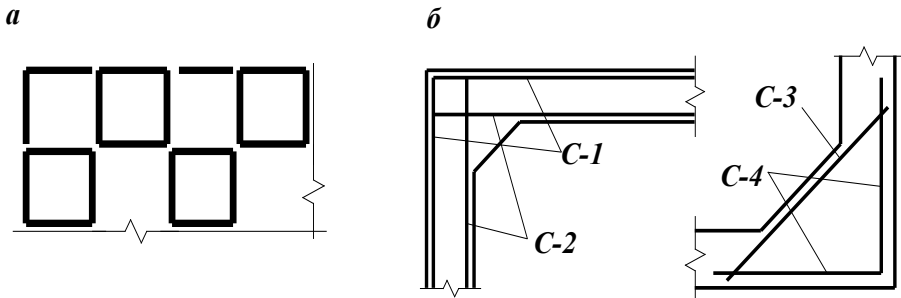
Схема розташування елементів у стільниковому силосі (а) та армування кутів стінок силосу (б)
